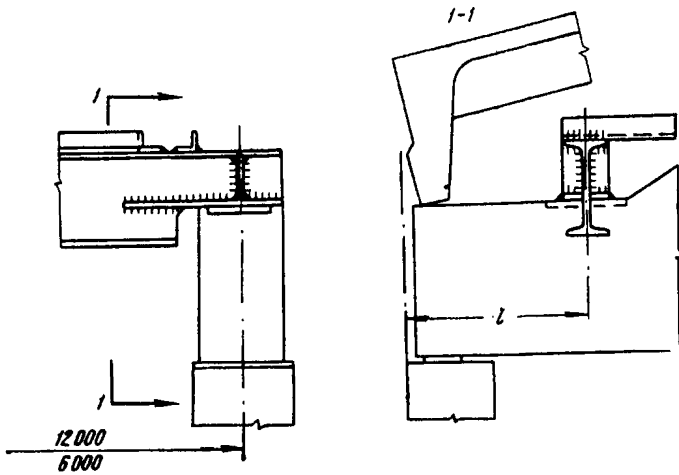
Крепление поперечной балки к опорному узлу фермы
